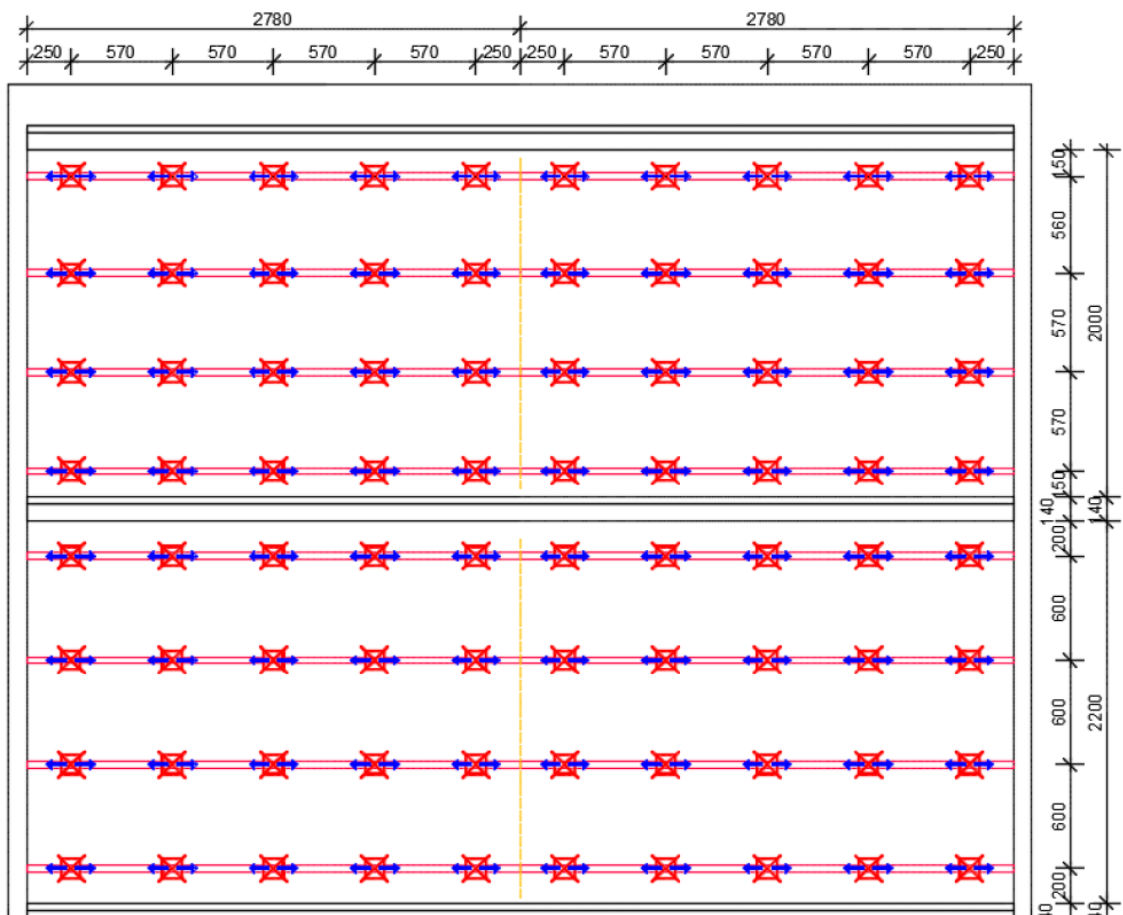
Wittmayergasse 2 – Ausschnitt Montageschema [HIL16]
